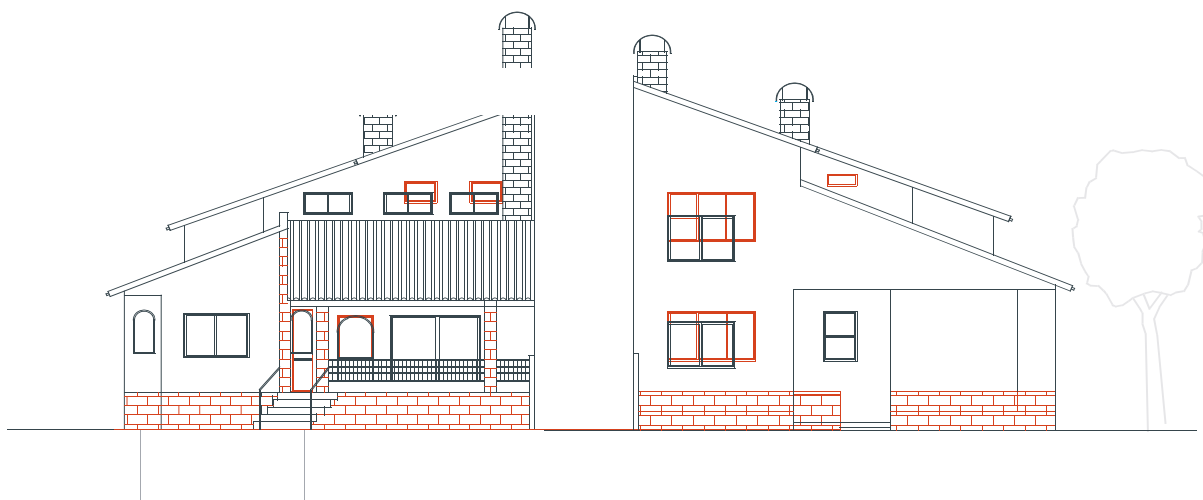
Planta dos Alçados - Existente. Fonte: autor
